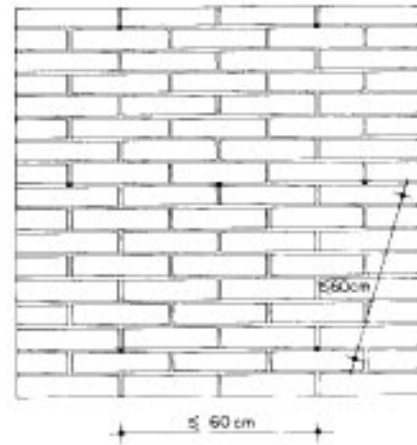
Muro doblado. Separaciones entre anclajes
